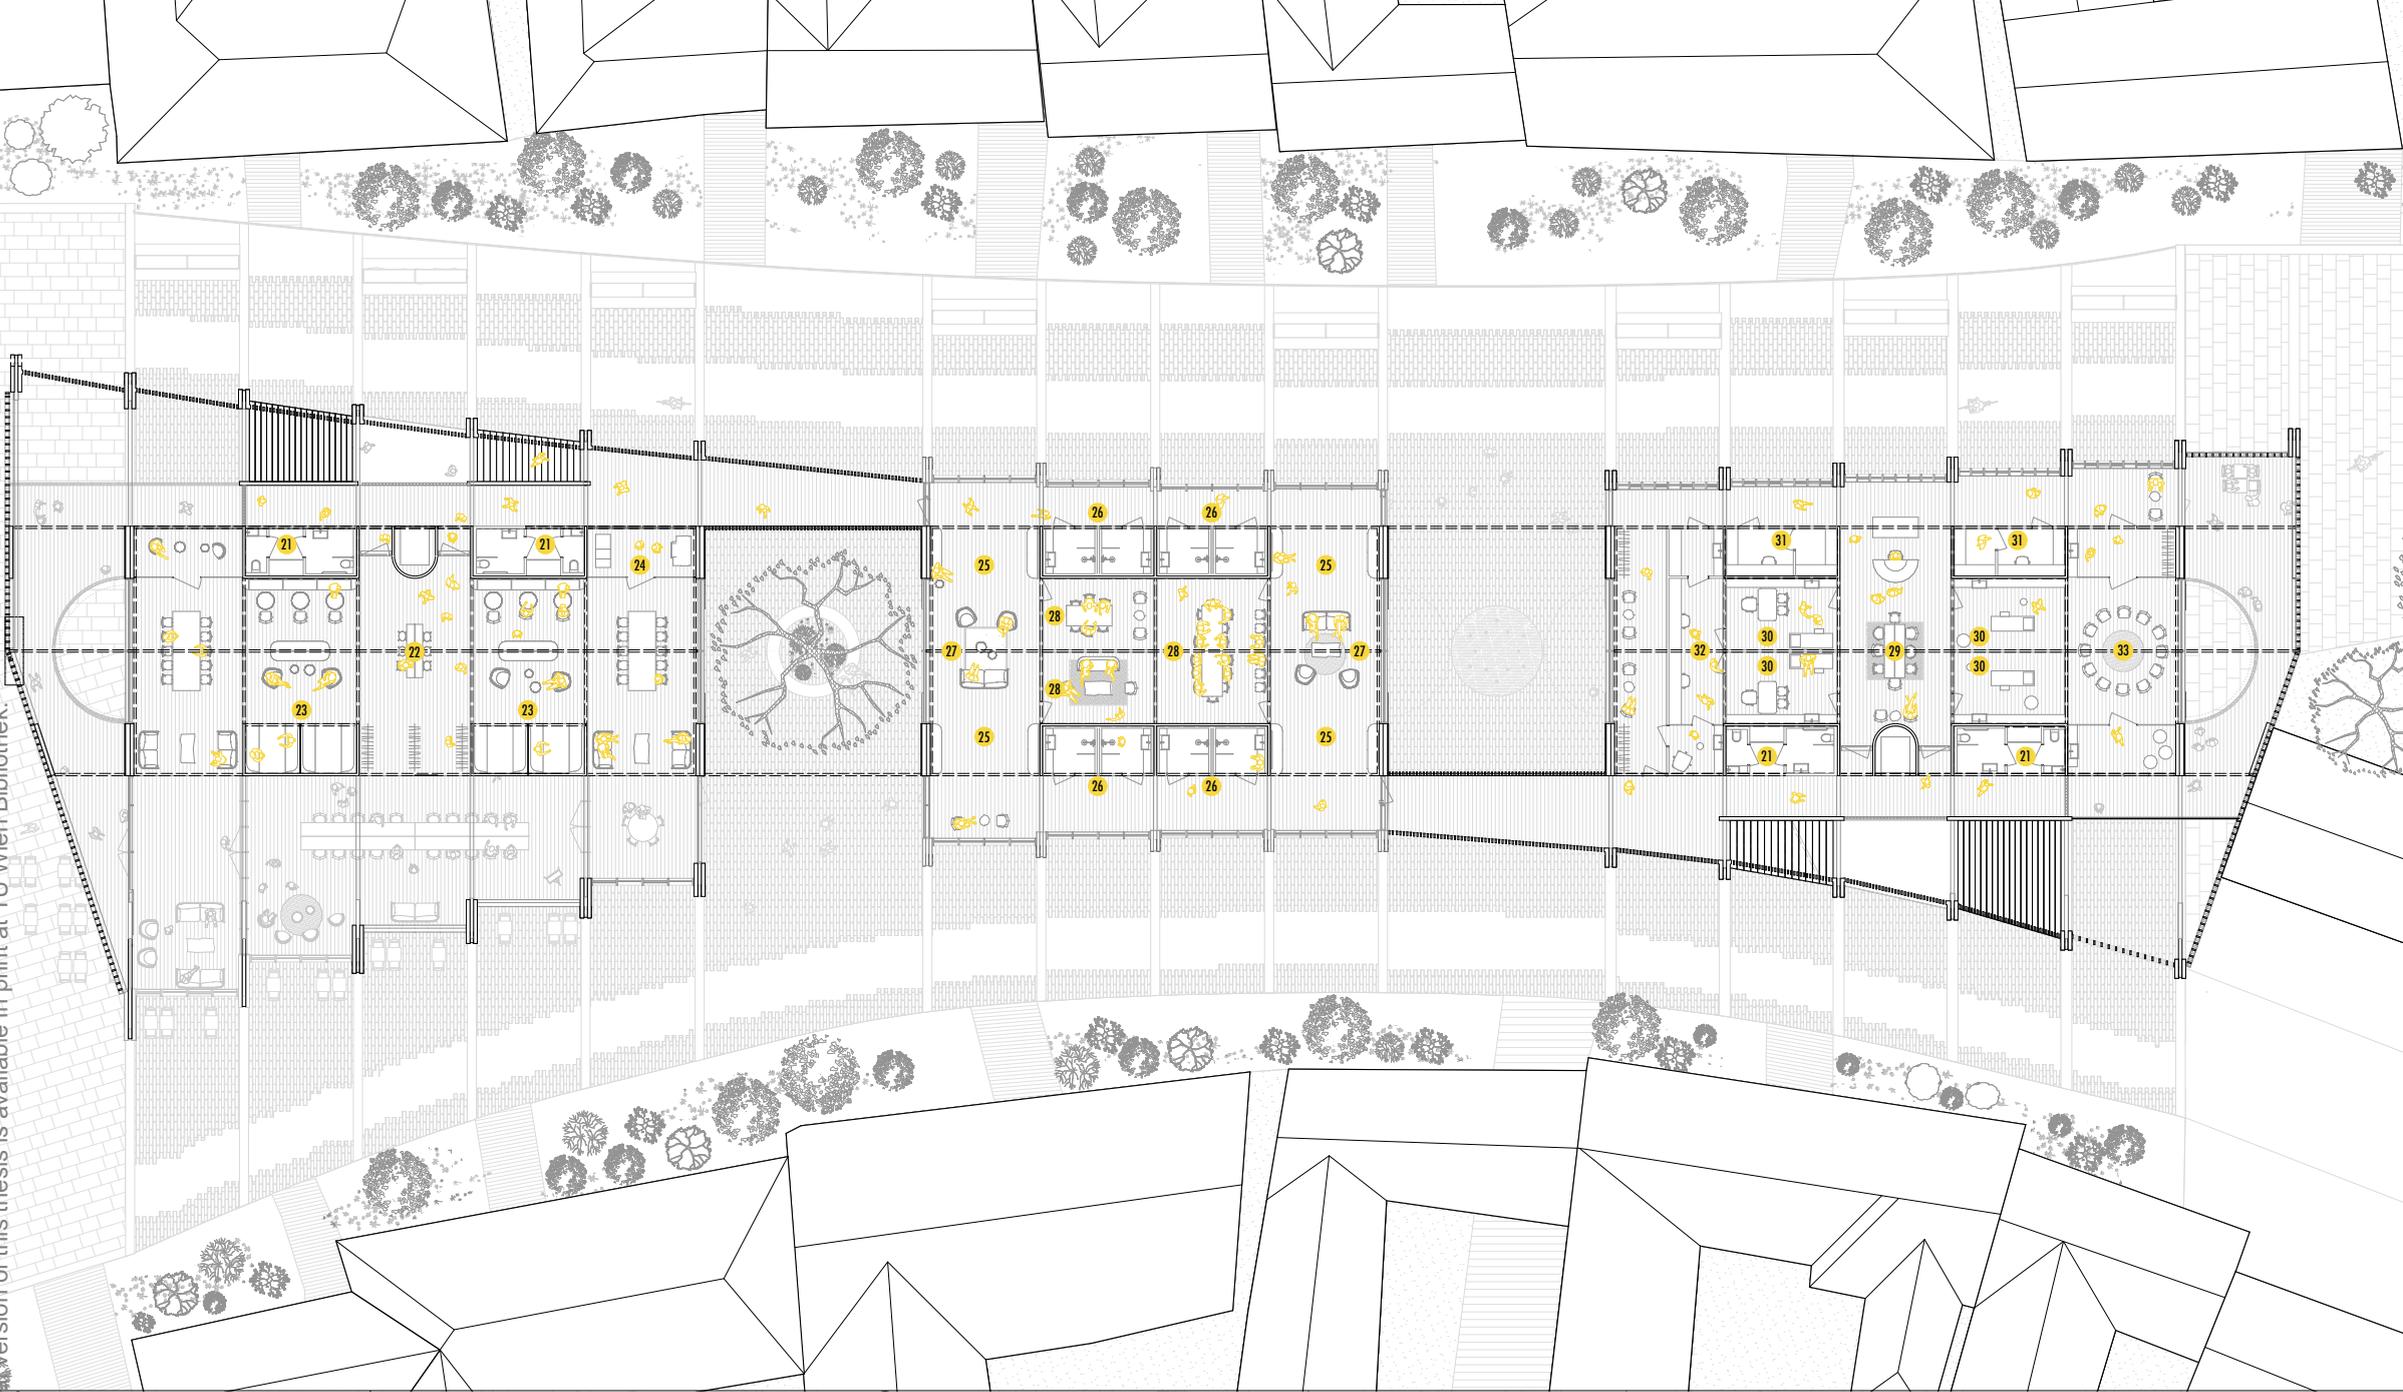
Grundriss Dachboden DSM, Maßstab 1:500.
